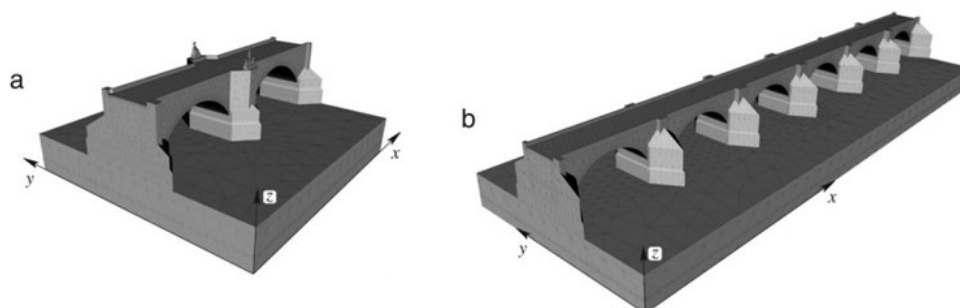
Modelo da Charles Bridge em Praga, adaptado de J. Zeman et al. (2008)
